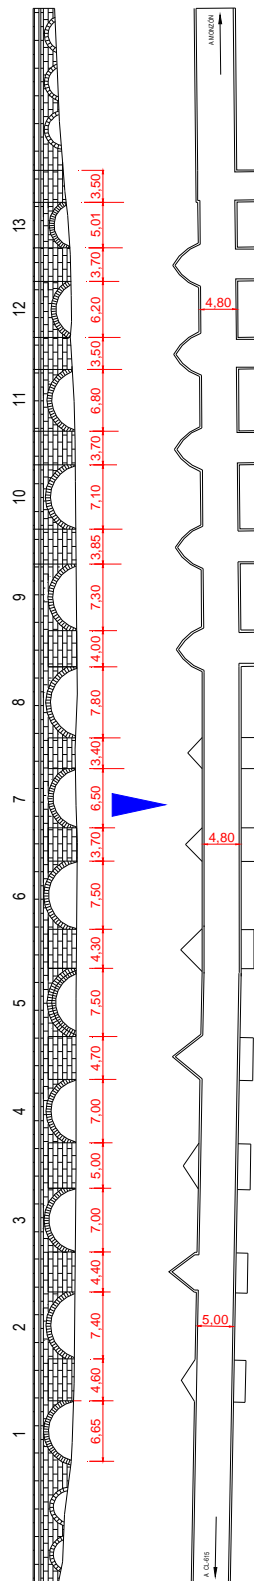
Planta y alzado de aguas abajo del puente en Monzón de Campos
